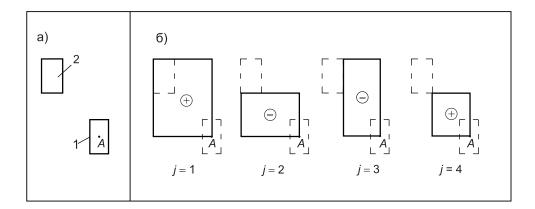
Схема расположения фиктивных фундаментов для определения дополнительных вертикальных напряжений σ<sub>zp,a</sub> в основании рассчитываемого фундамента методом угловых точек с учетом влияния на его осадку соседнего фундамента:
